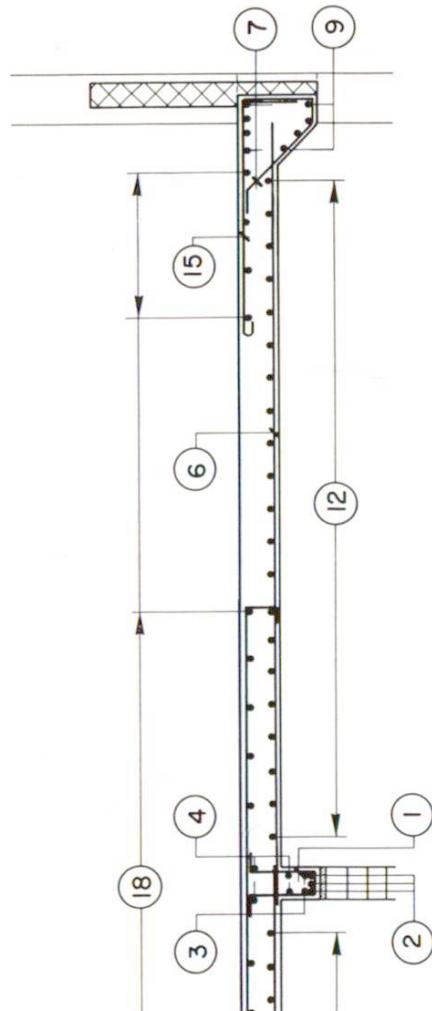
Exemple d'utilisation de la liste de pose, en combinaison avec le plan d'armature
